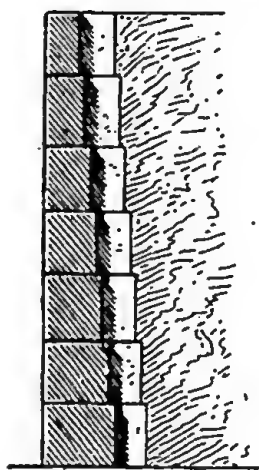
Coupe du mur de Khorsabad (d'après Place).
